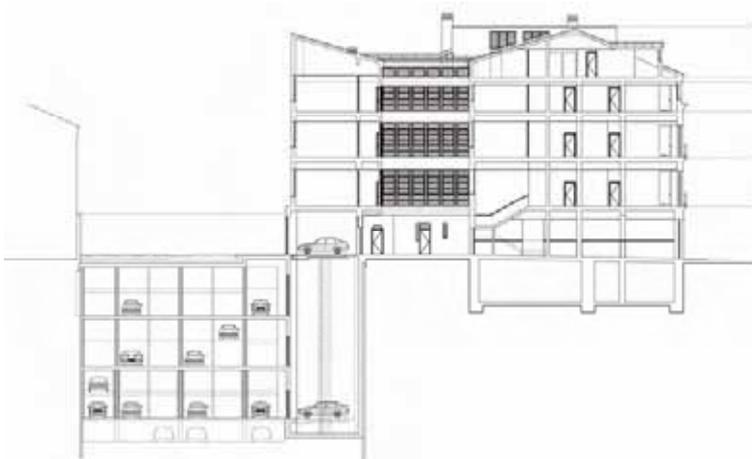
Construcción de un aparcamiento robotizado con 39 plazas bajo el patio de un edificio protegido en la C/ Santa Isabel, 21 (Madrid).
